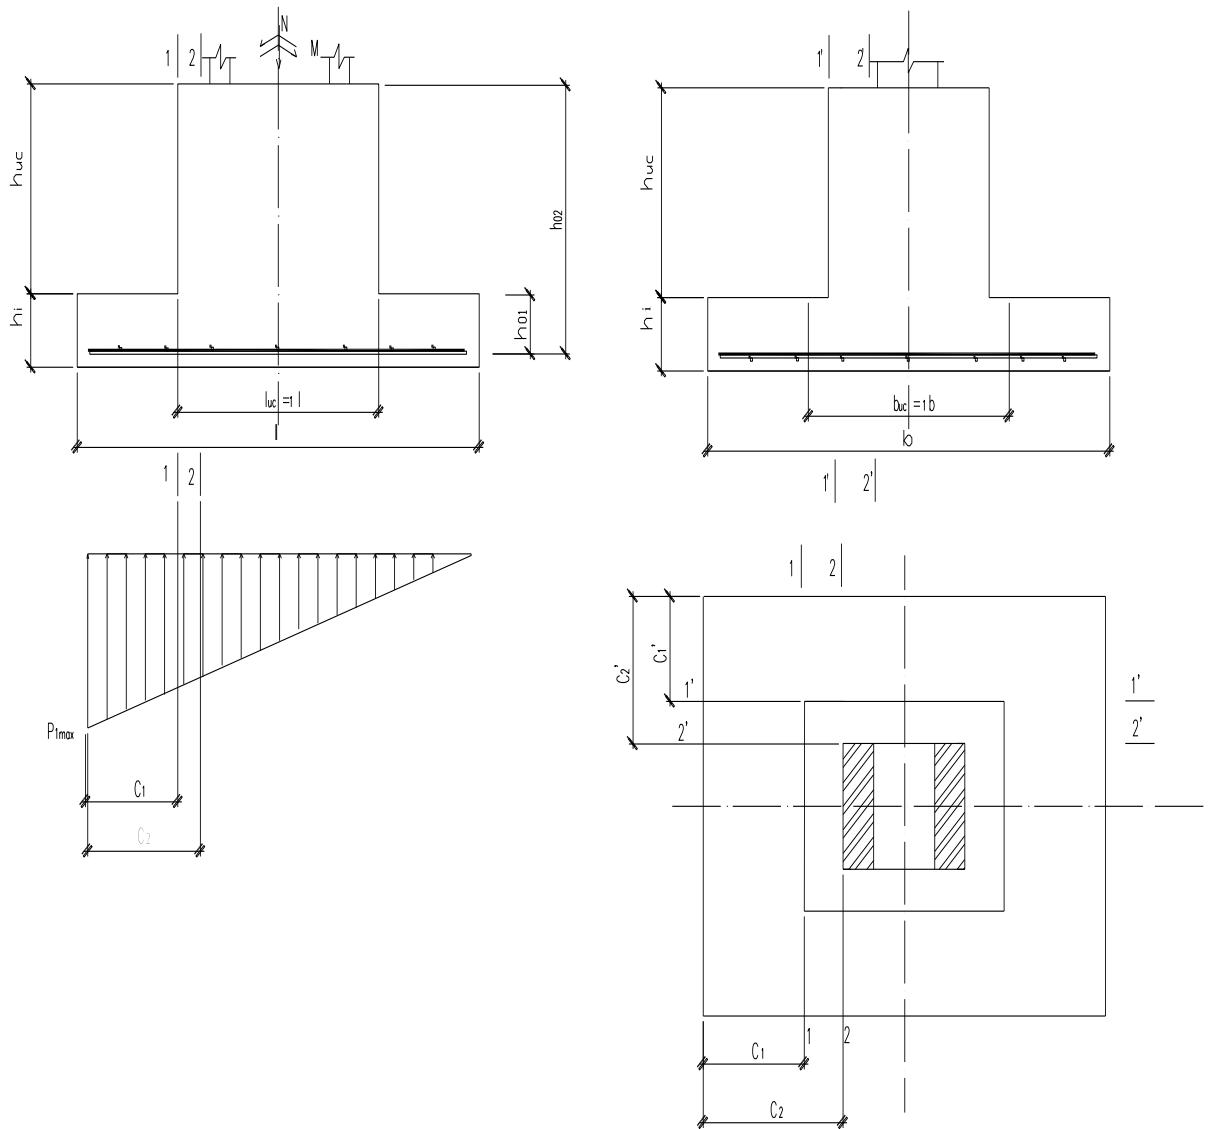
Расчетные схемы для определения арматуры внецентренно нагруженного фундамента
